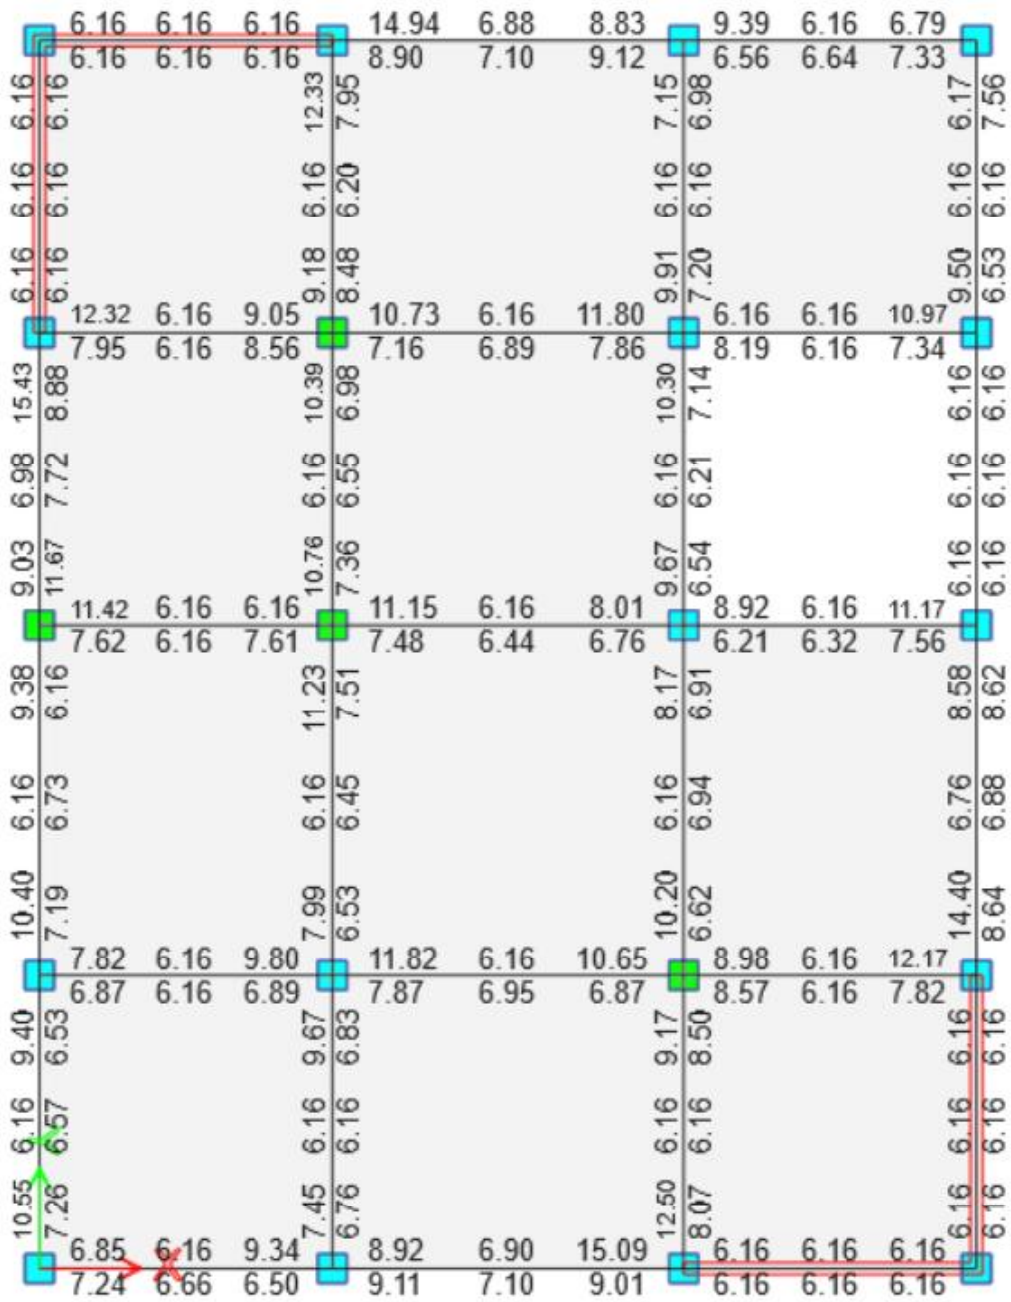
Refuerzo Longitudinal Vigas cm^2 – Losa $Nv+21.00$ m – Estructura 8 Pisos
